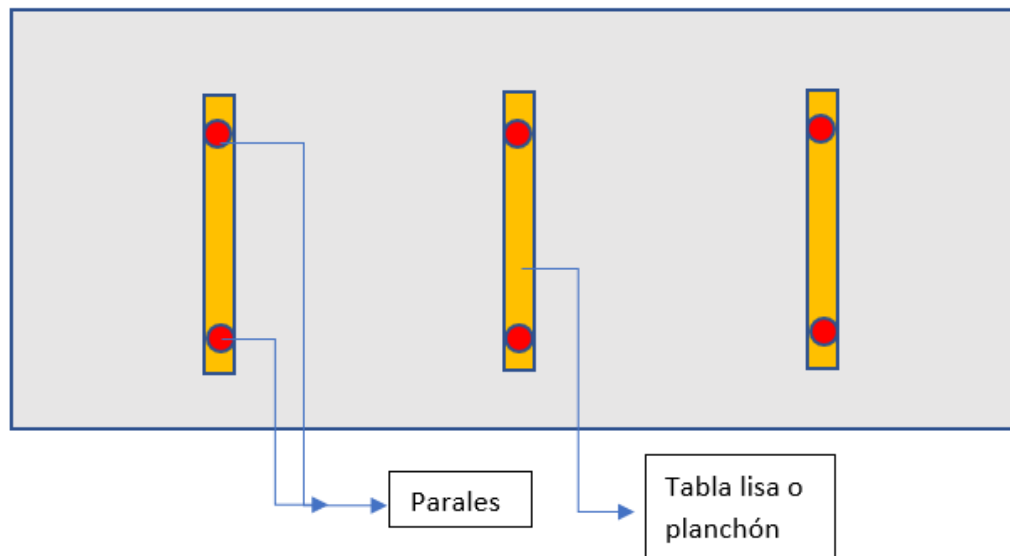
Ubicación paraleles de apoyo bajo la losa de cubierta a intervenir.
